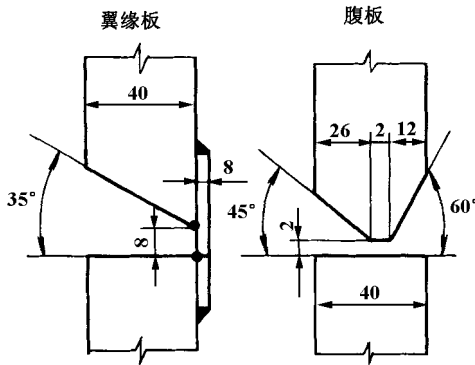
H 型钢柱 - 柱安装拼焊坡口形式及尺寸
